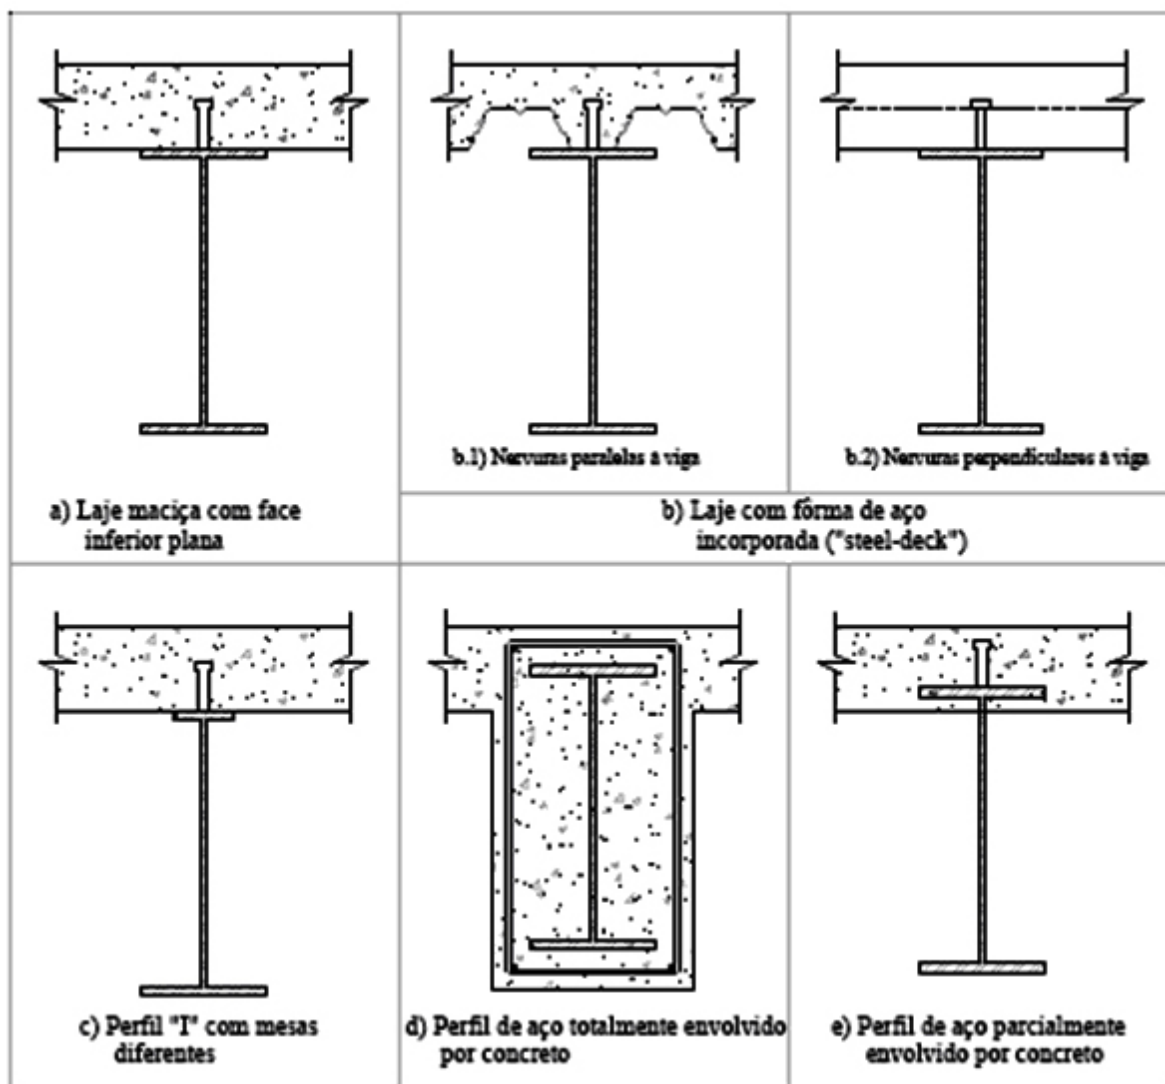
VIGAS MISTAS COM LAJE MACIÇA
